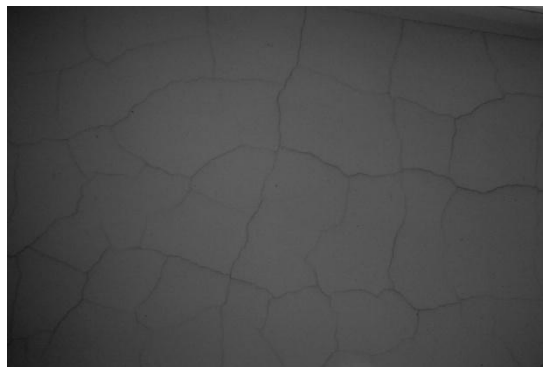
Fissuração mapeada em parede de alvenaria devido a retracção
